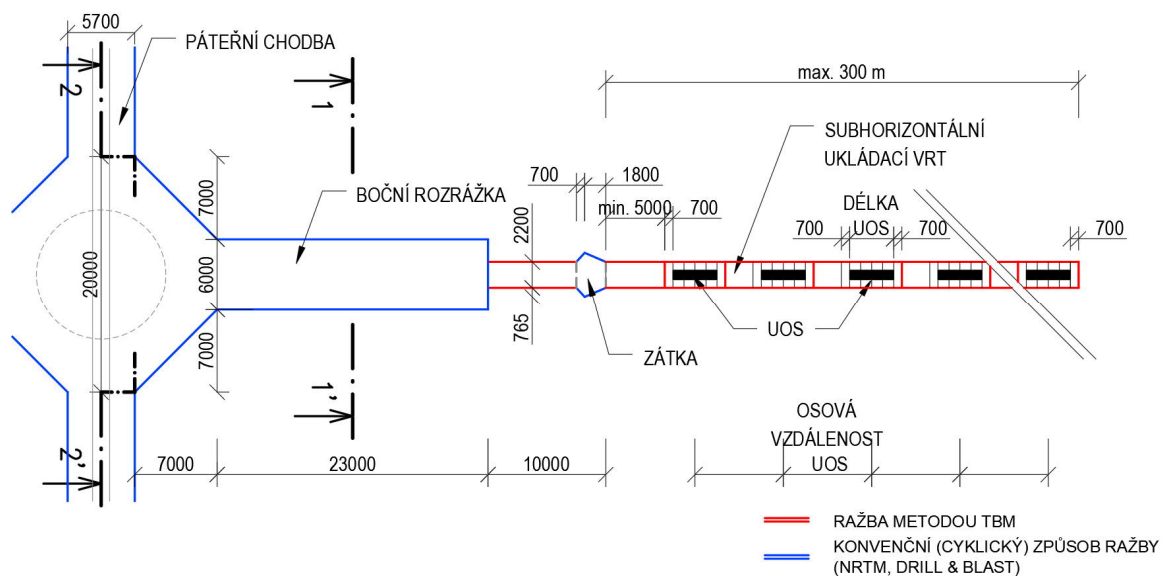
Půdorysné schéma ukládání – varianta D3
